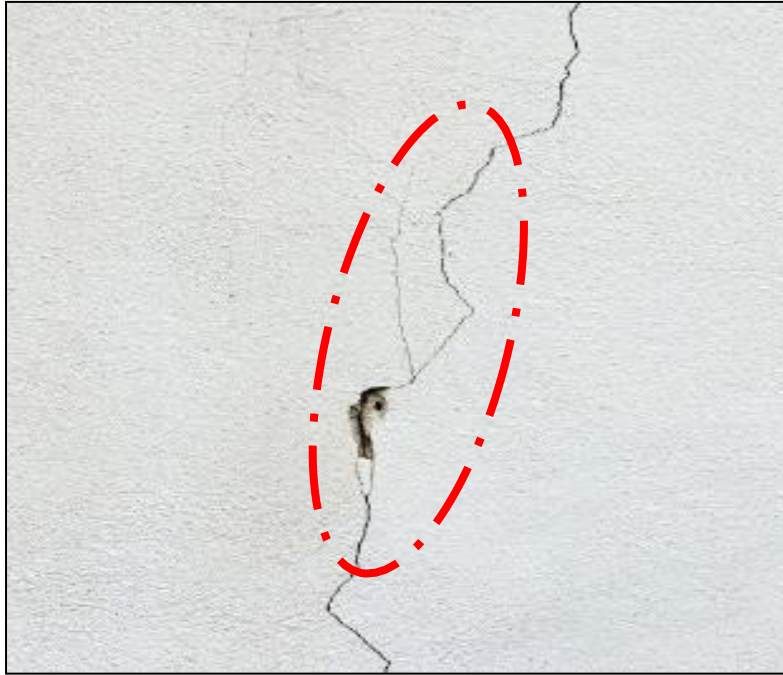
Fisuras en el tarrajeo de muros
